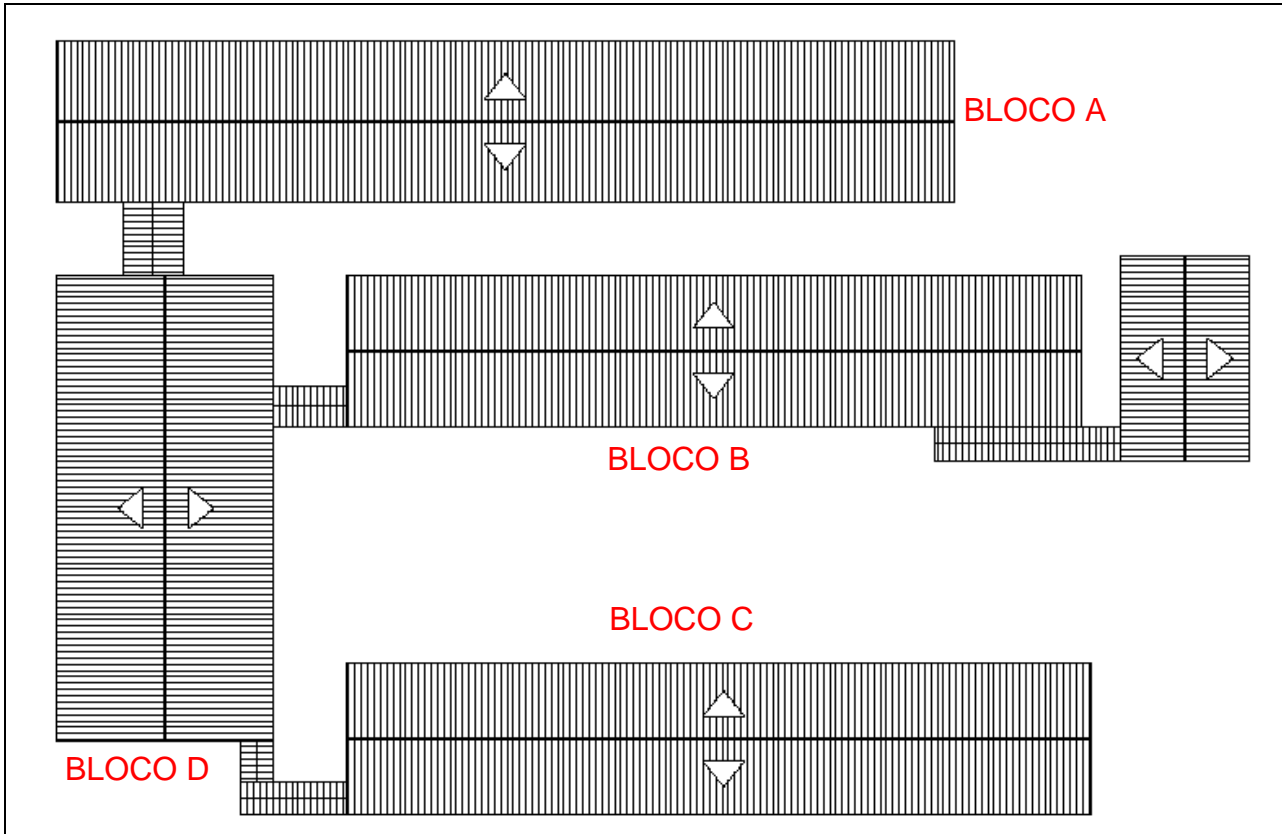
Planta baixa Cobertura. (Fonte: PMC)
